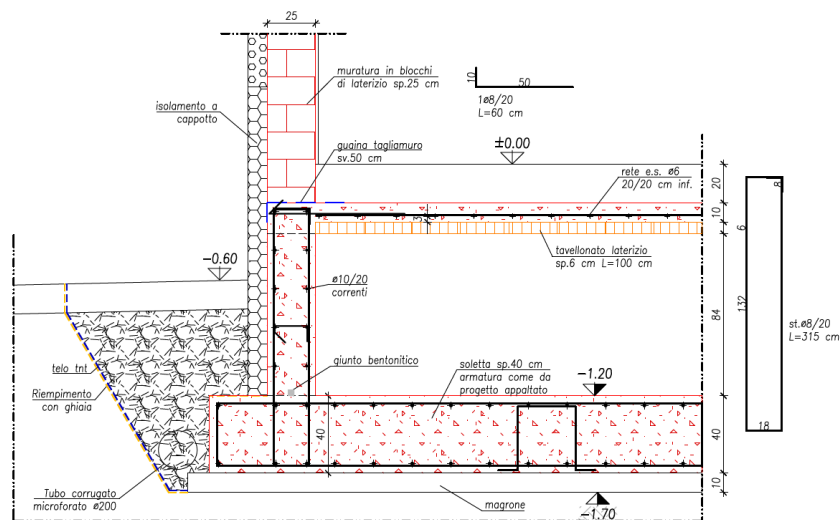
Stalcio della nuova fondazione a platea del vano tecnico
